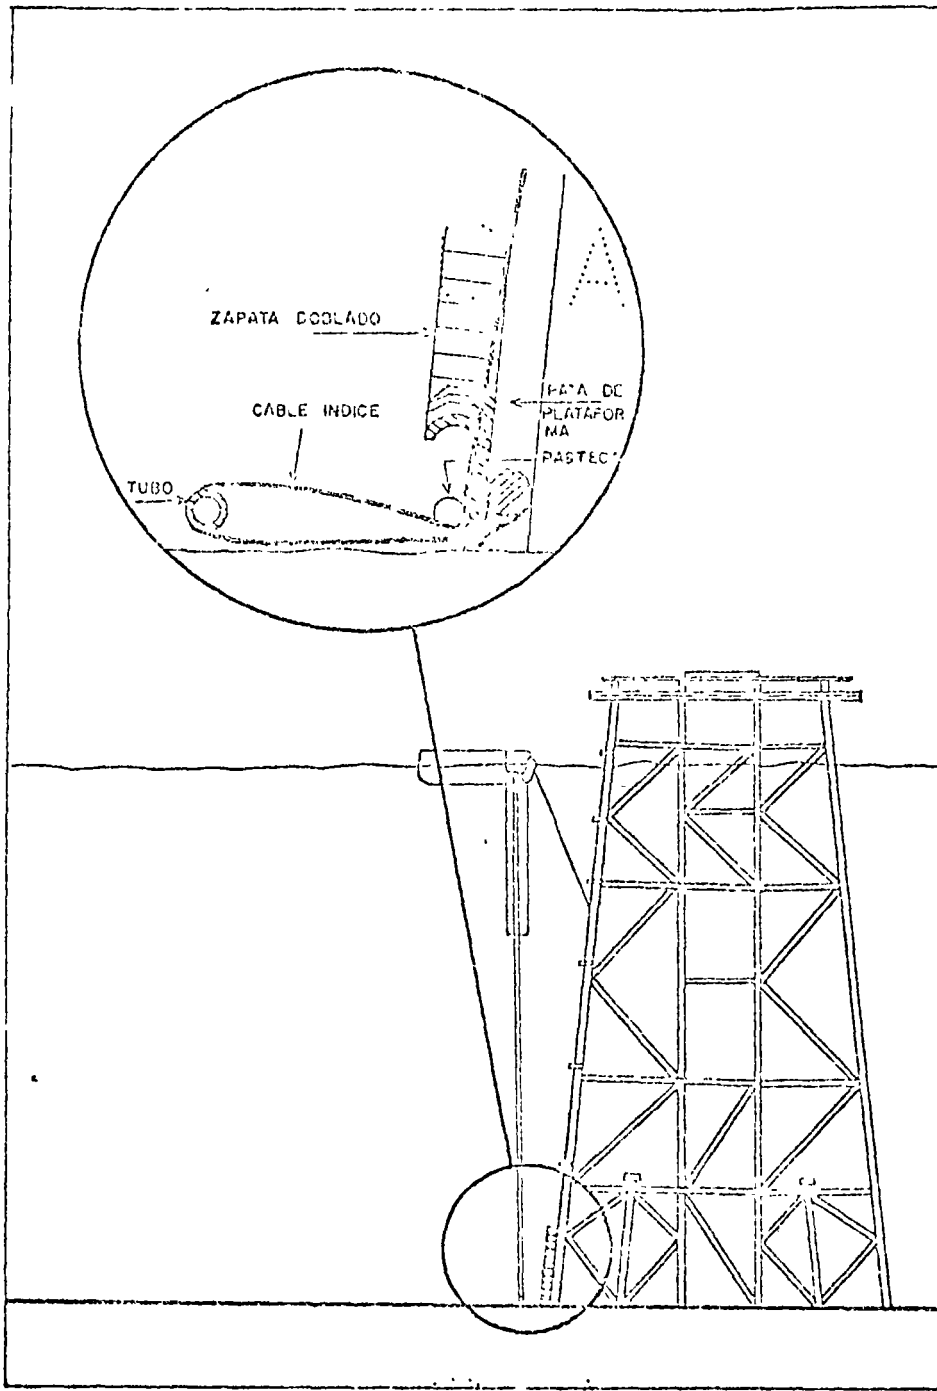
Dispositivo emergencia para colocar la tubería bajo la Zapata
